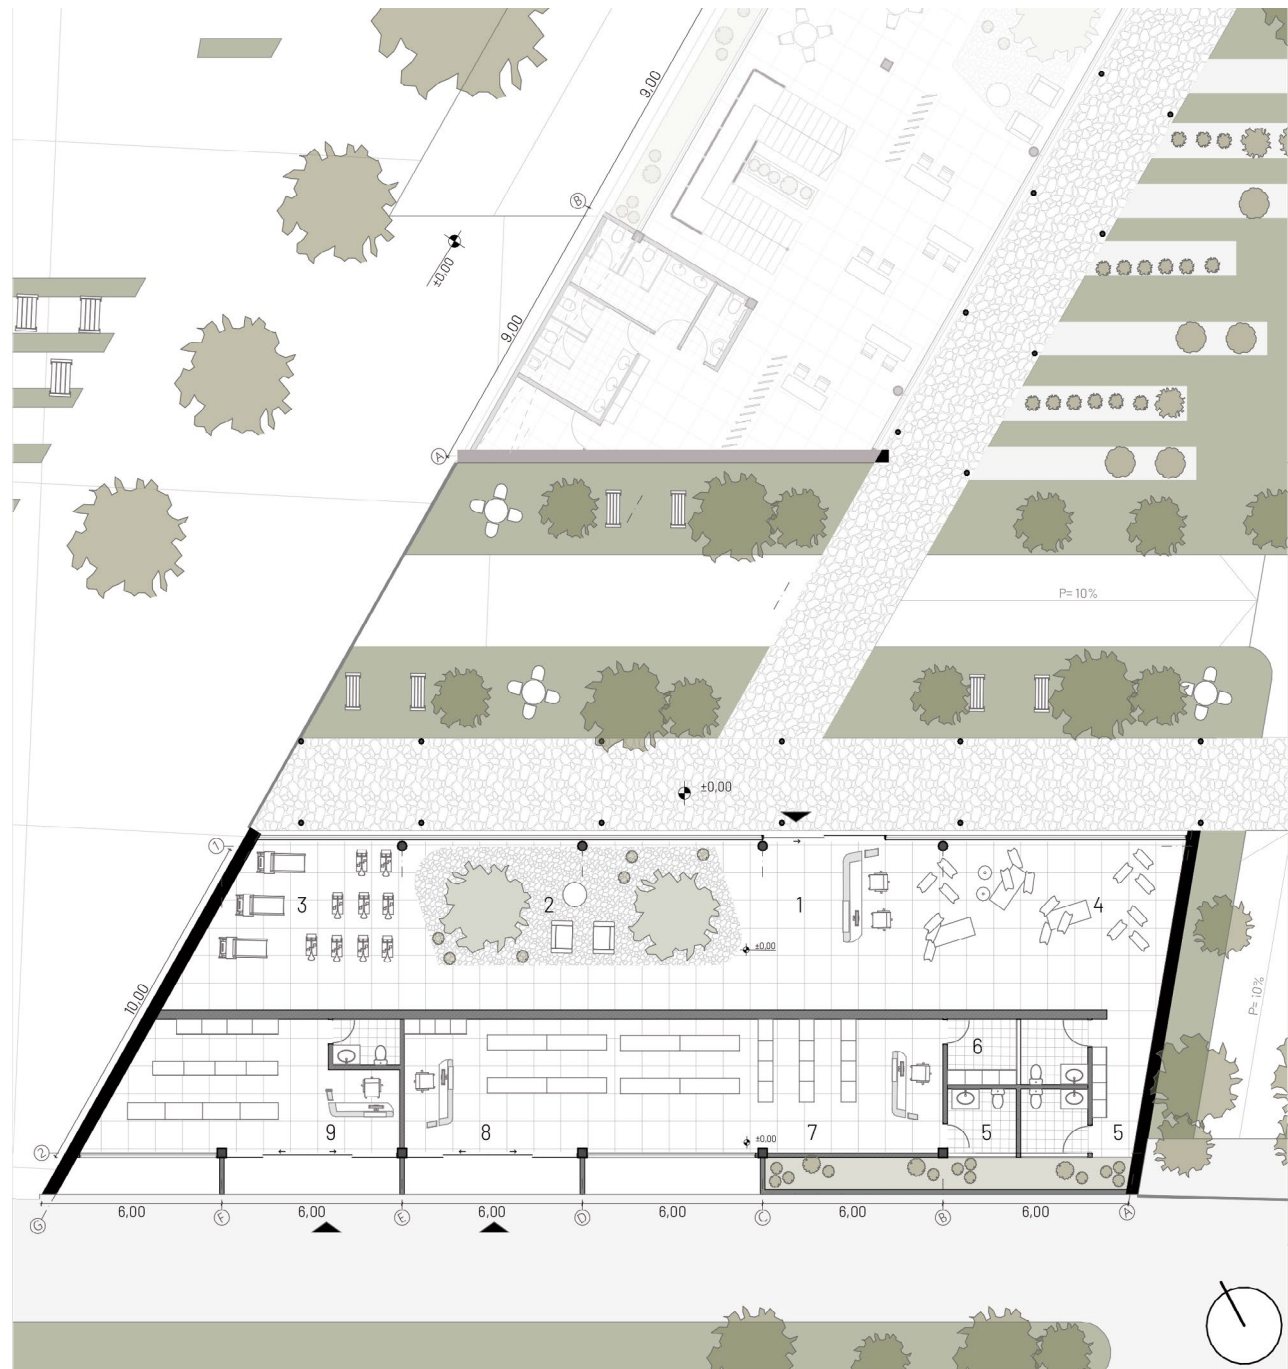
| Planta Baja | Fuente: Autoria propia. (2023).
